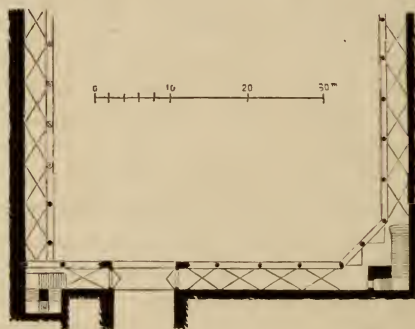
Grundriss des Schlosshofes zu Brieg.
